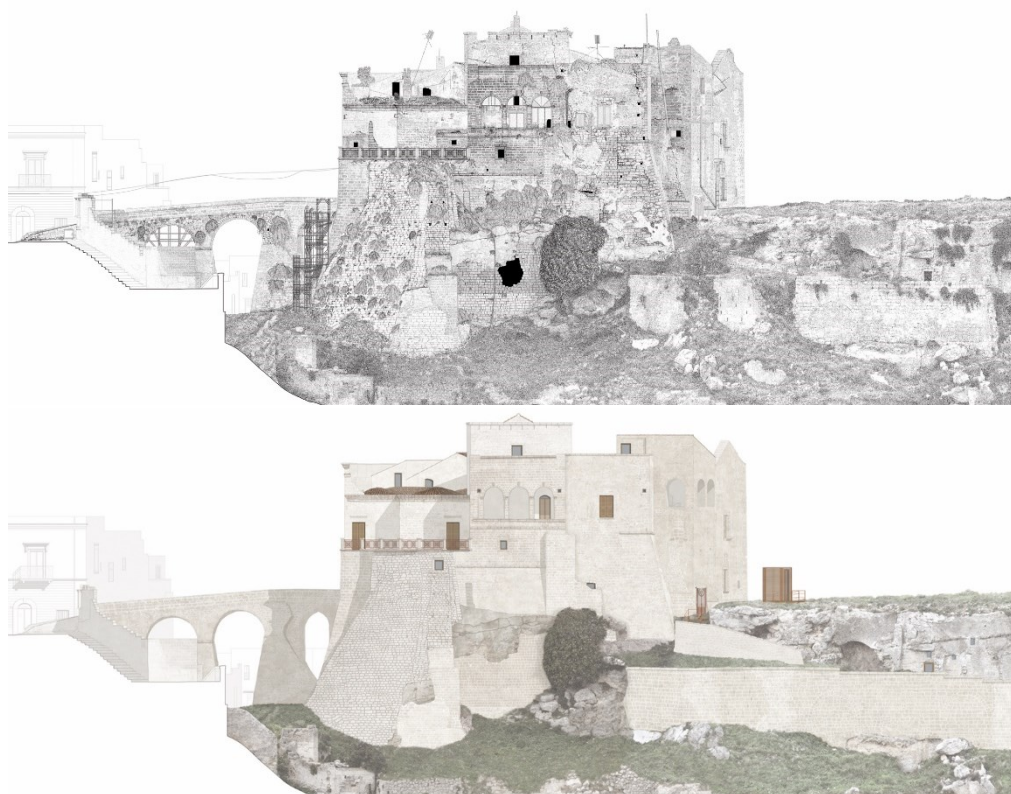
Prospetto sud est prima e dopo l'intervento di restauro proposto (Albanese et al, 2016)
